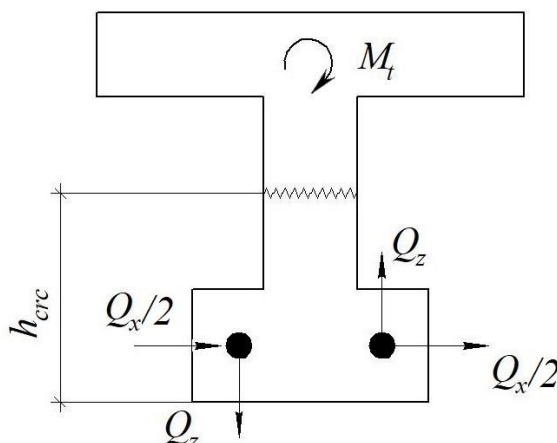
Схема нагельних сил в поздовжній арматурі елемента двотаврового перерізу
